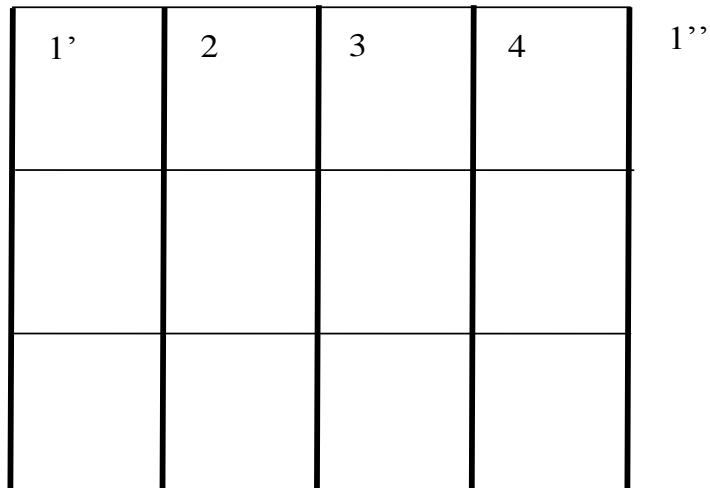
Плоске розгорнення металевої арматур залізобетонної опори
